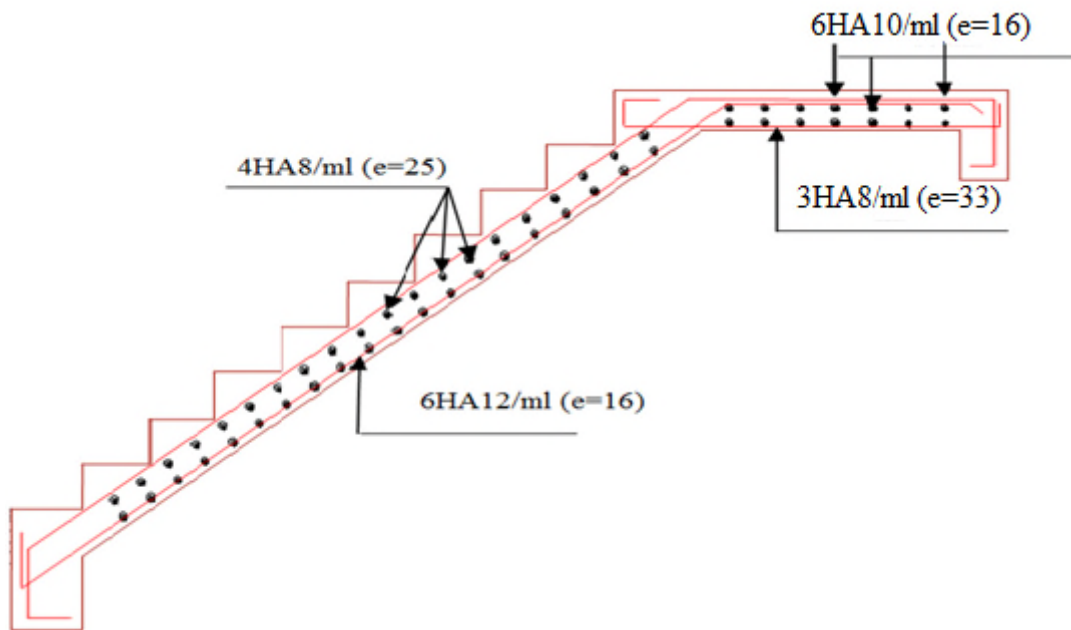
Schéma de ferrailage de l'escalier Type 1
